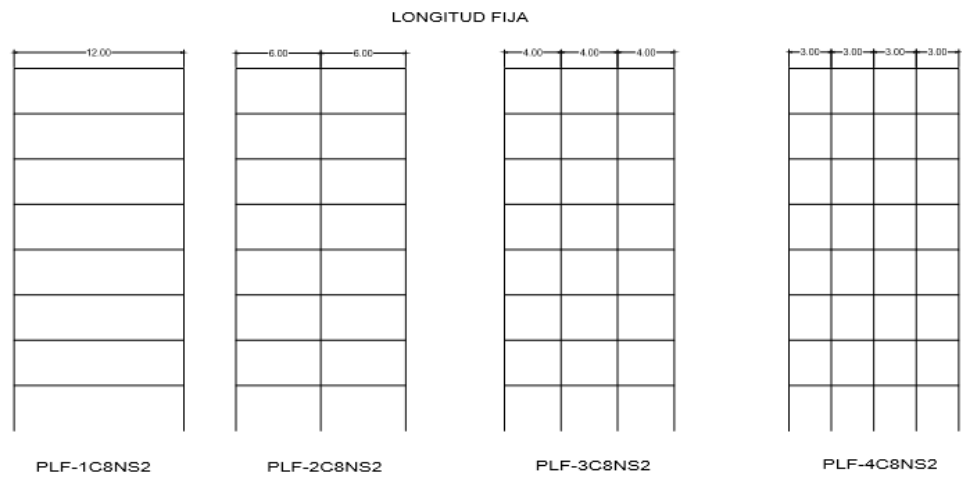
Pórticos de Longitud fija de 8 Niveles (PLF8N)
